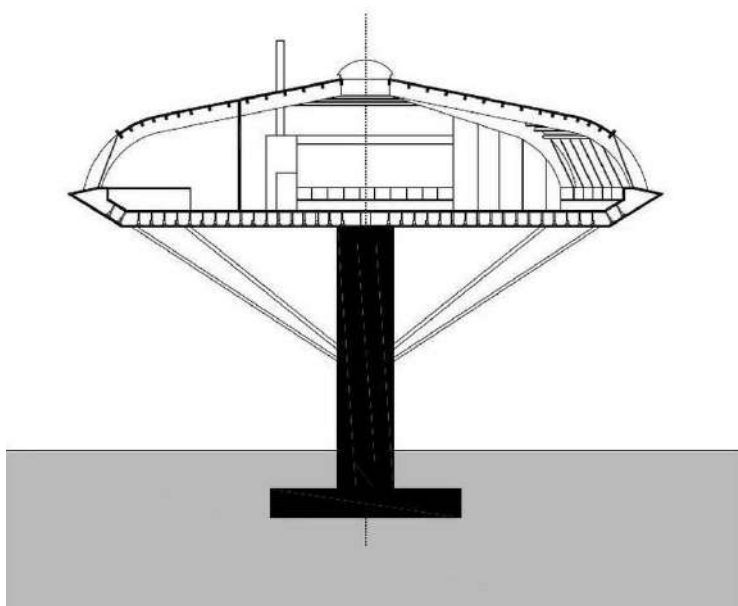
Чертеж разреза для реконструкции
